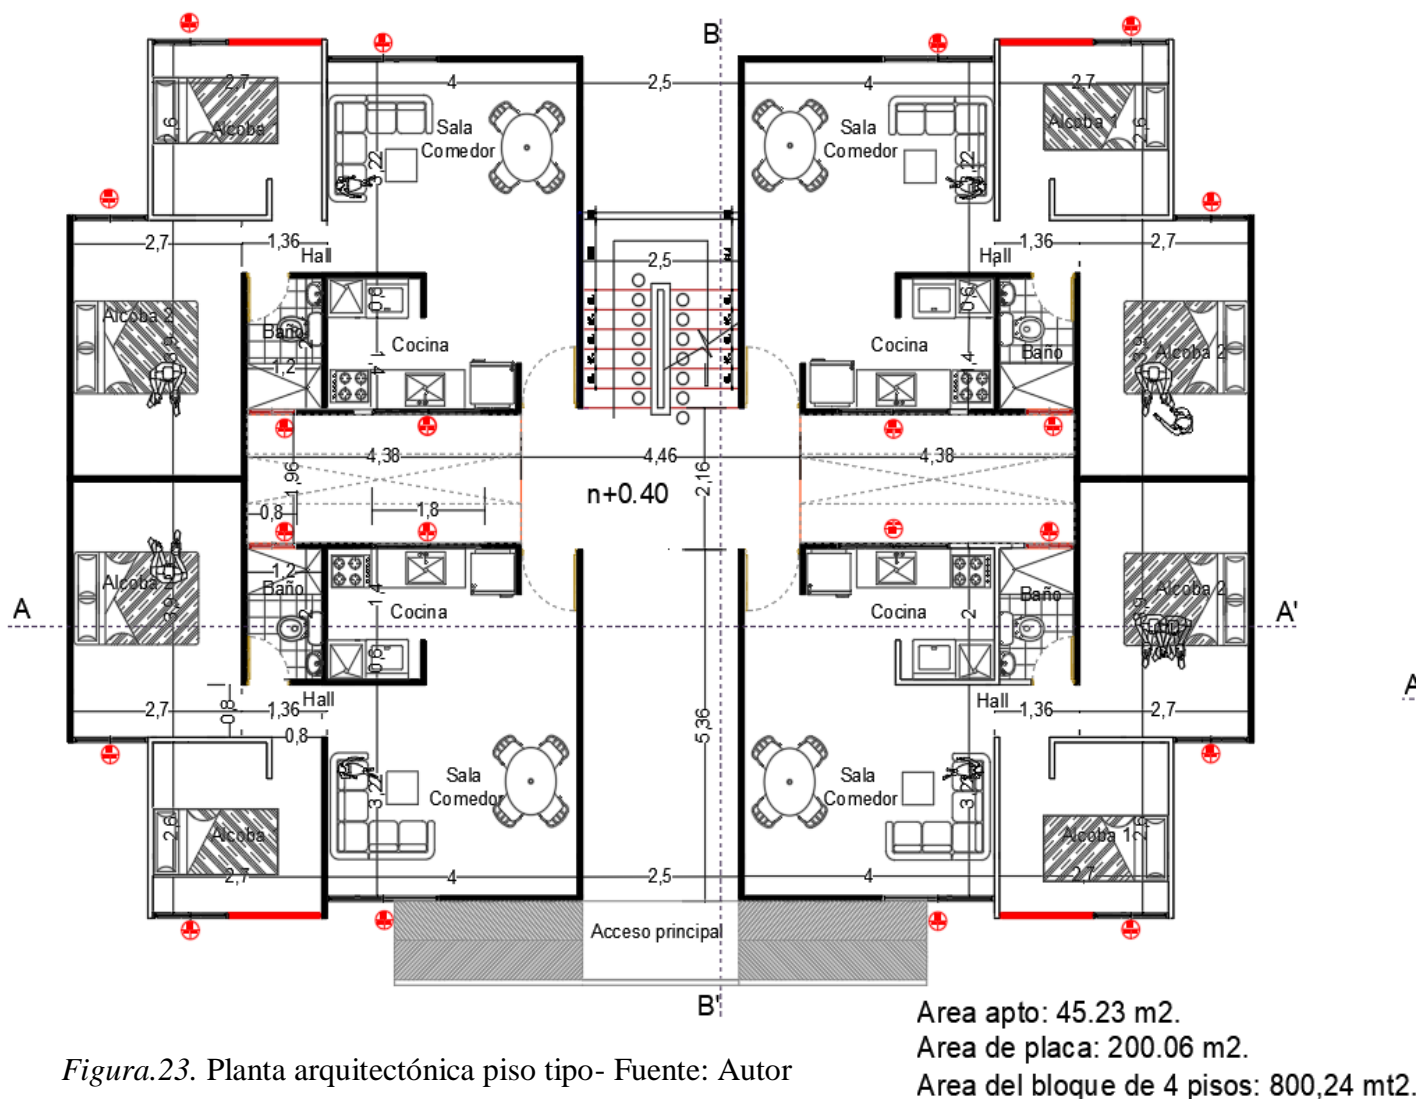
Planta arquitectónica piso tipo- Fuente: Autor
